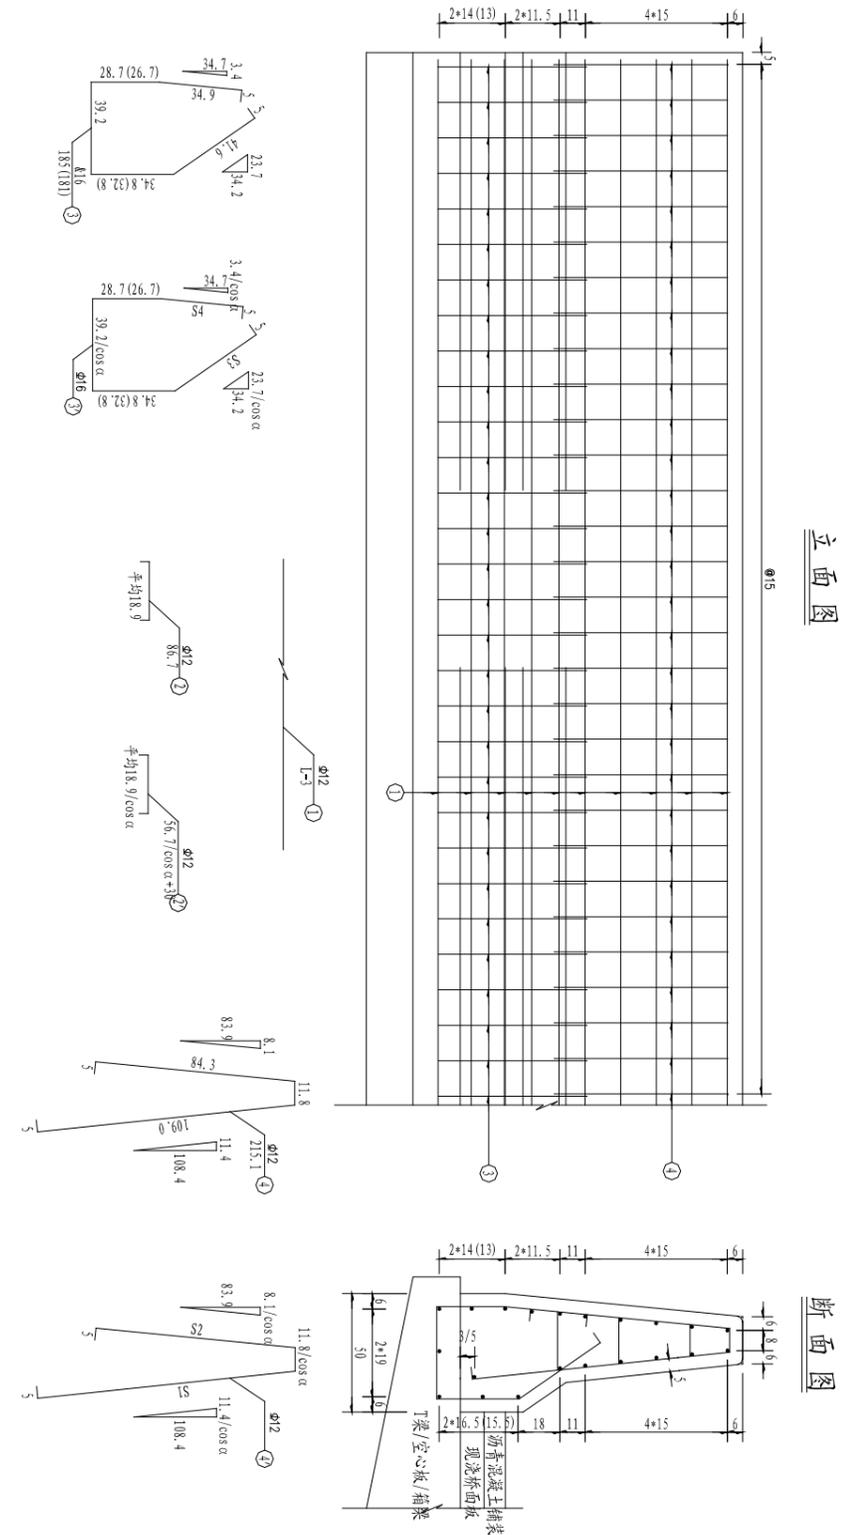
混凝土部分配筋详图 (尺寸单位: cm)
